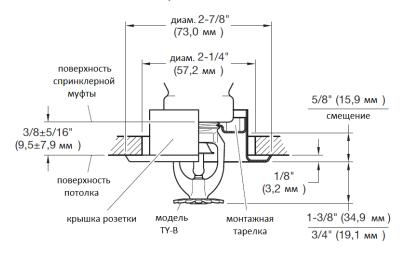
Сборка оросителя розеткой вниз модель ТҮ-В (ТҮ325), углубленная установка с декоративной розеткой Style 15, высота регулировки 5/8" (15,9 мм)
